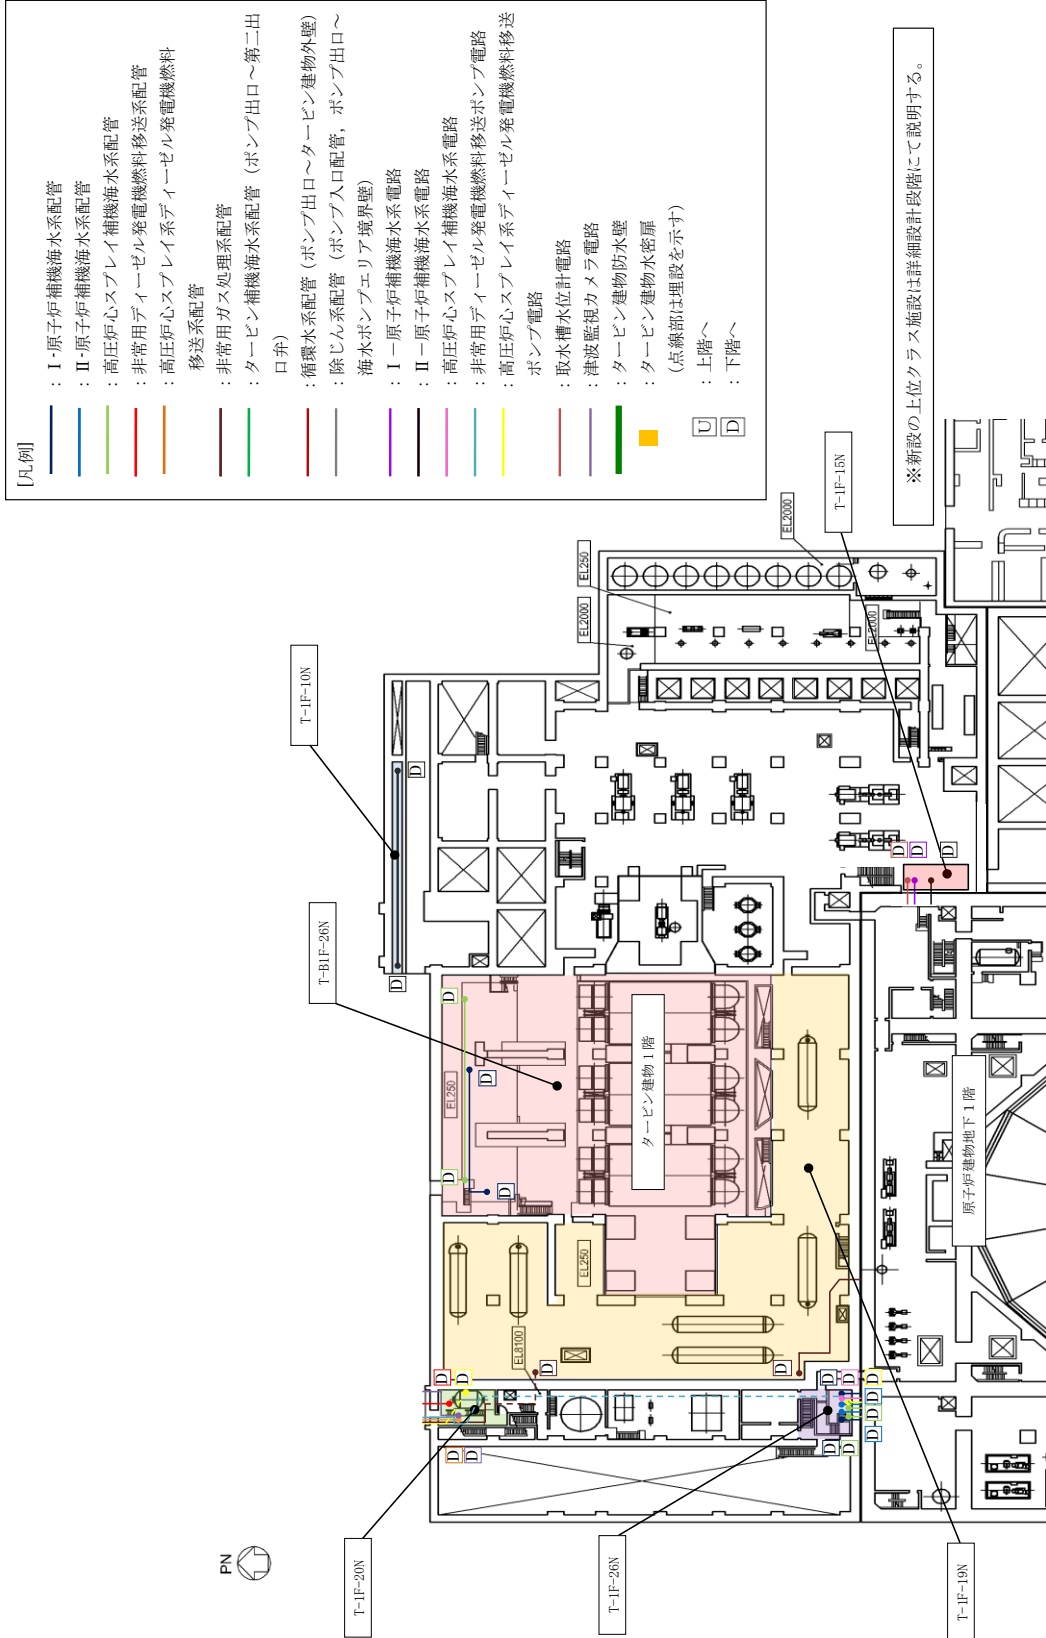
取水槽及びタービン建物内の上位クラス施設の配置図 (2/2)
